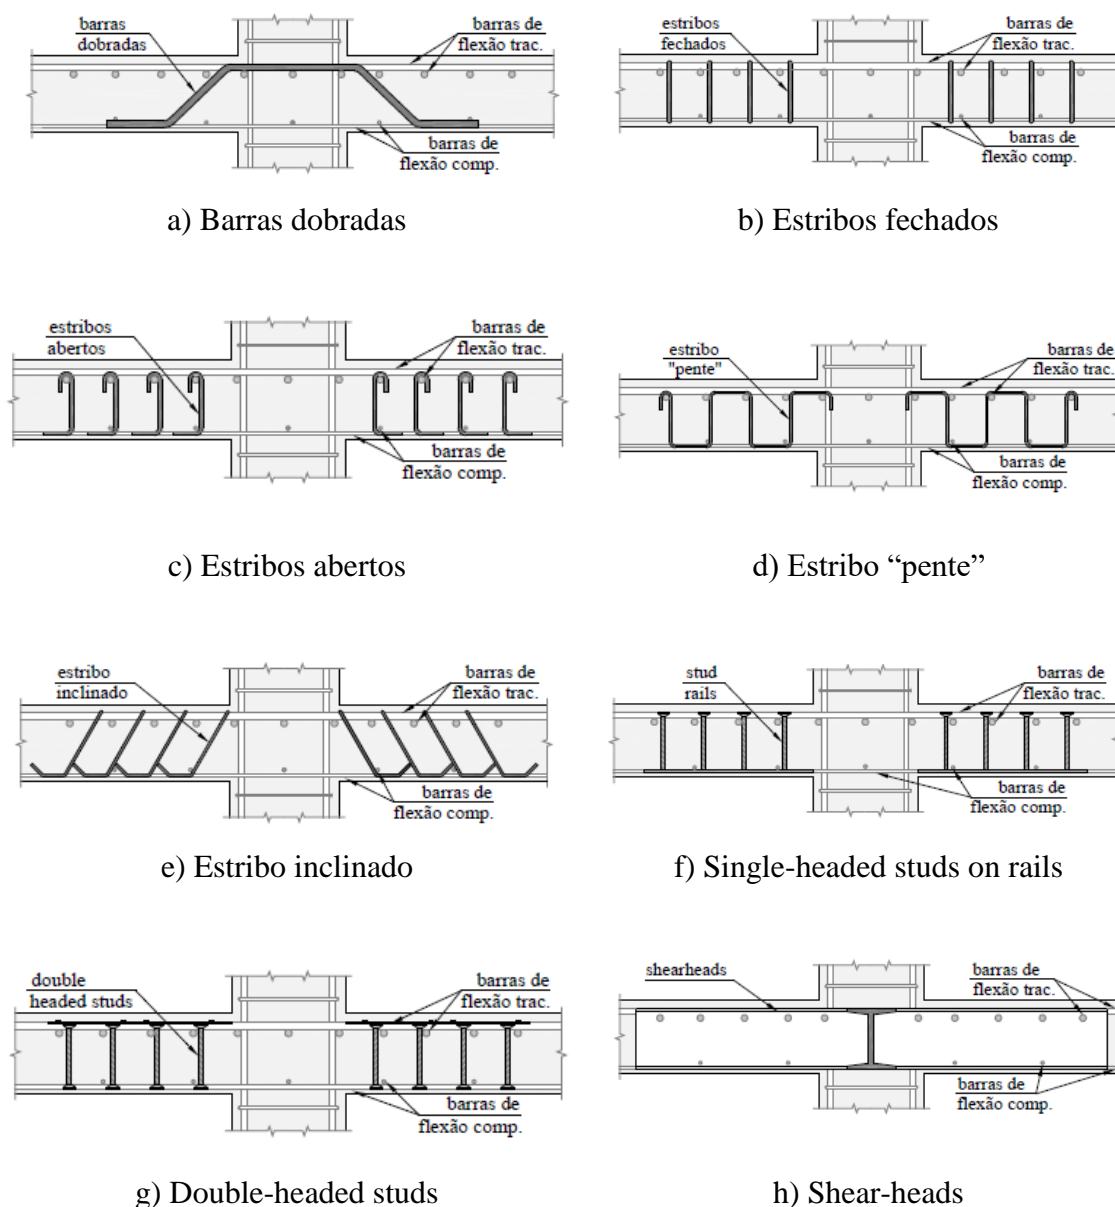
Armaduras de cisalhamento do tipo estribos e barra dobrada (FERREIRA, 2010).
